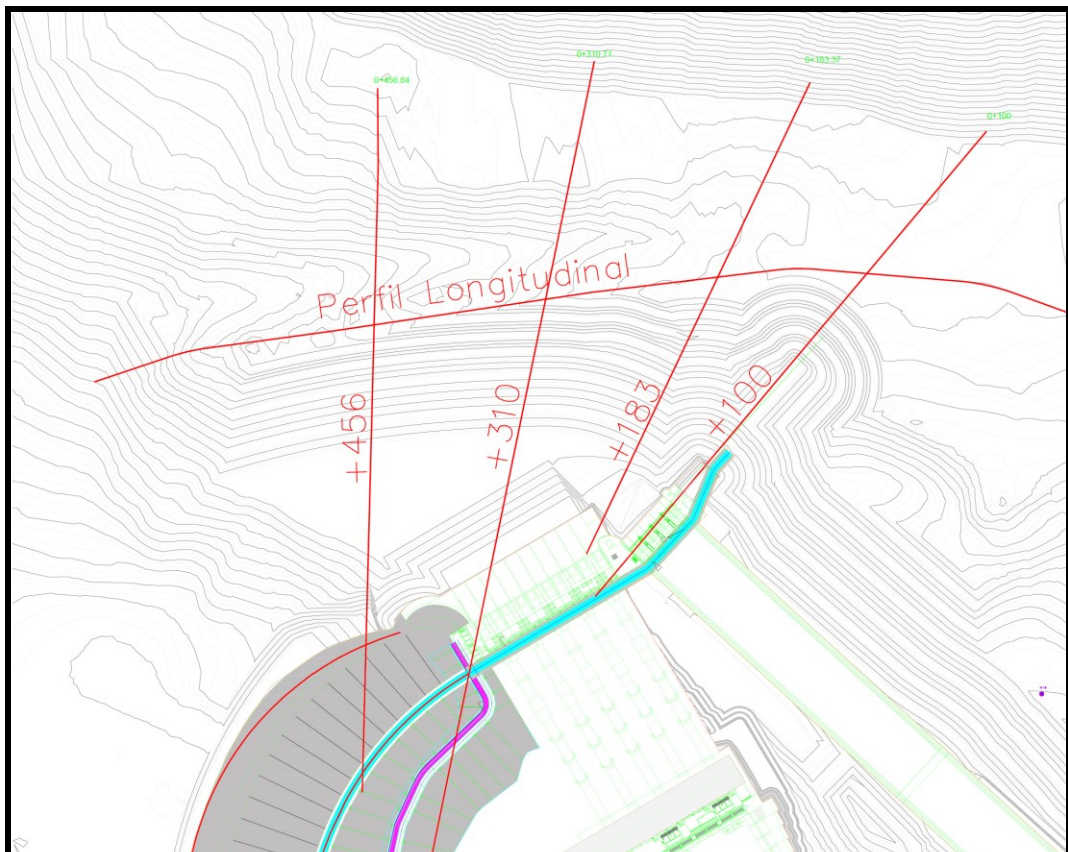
Planta general con la ubicación de los perfiles de las Figuras 14.29 a 14.33
